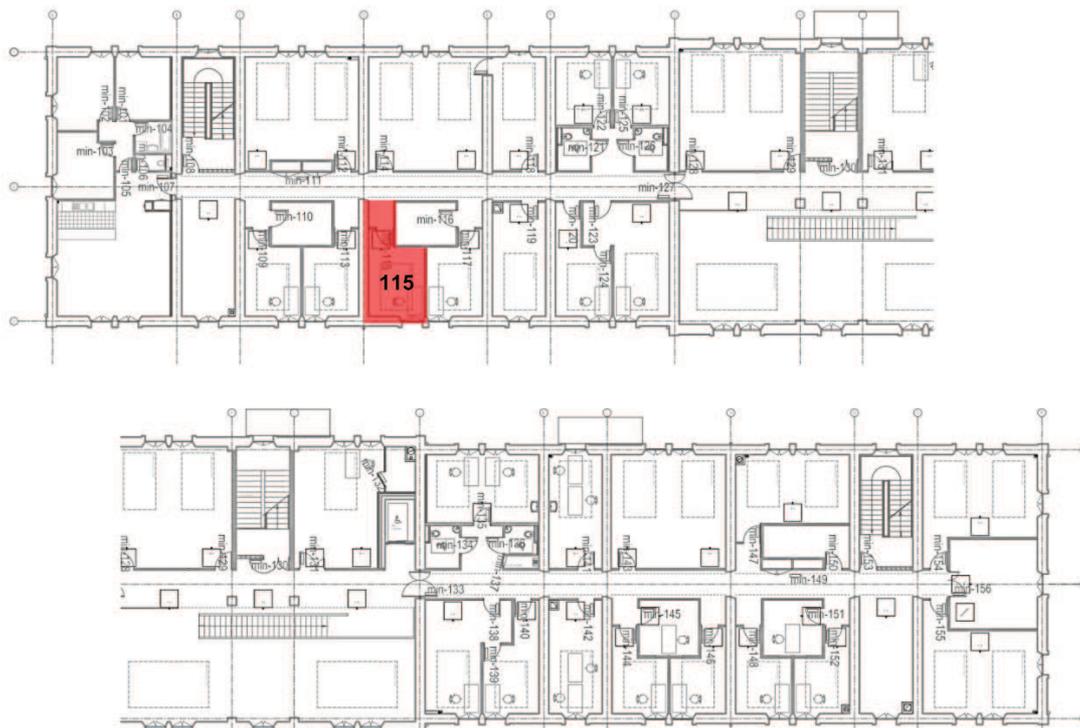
Plan du bâtiment SJA3 du campus Saint Jean d'Angely (1^{er} étage)
